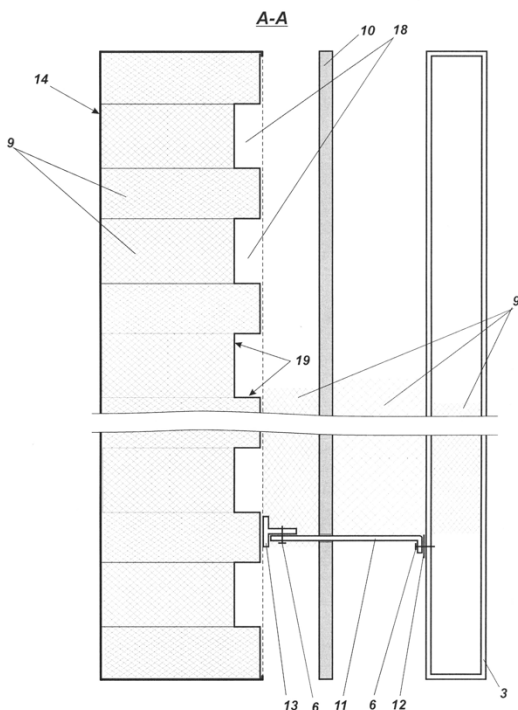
Сечение А-А [4] на рис. 1, где: 6 – элемент крепления; 9 – утеплитель; 10 – плита; 11 – установочные кронштейны; 12 – теплоизоляционная подложка; 13 – лаги Т-образного профиля; 14 – сэндвич-панели; 18 – воздушные каналы; 19 – ступенчатый элемент.
